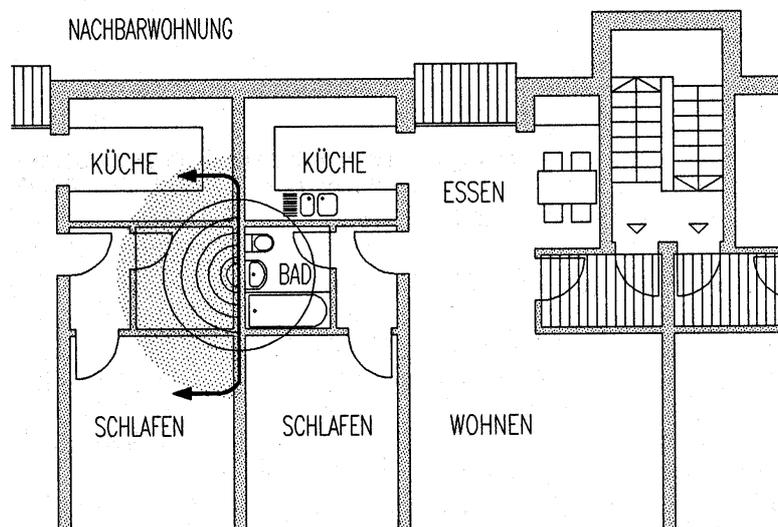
Schallmäßig ungünstiger Grundriß (Pi, B 70/1)
